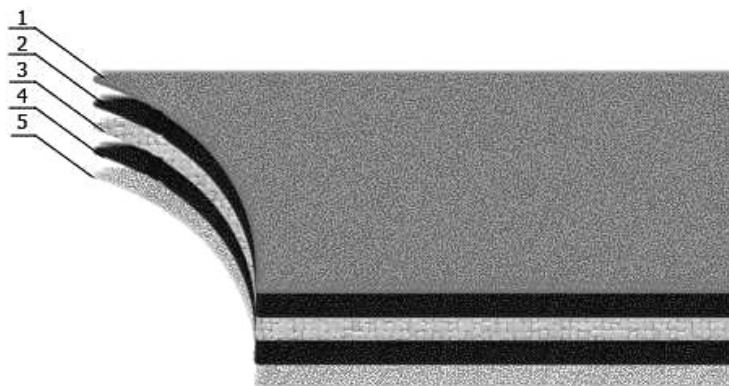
Общий вид продукции: 1 – верхний защитный слой (крупнозернистая или мелкозернистая посыпка, или пленка); 2 – верхний слой ПБВ; 3 – основа (нетканый полиэстер); 4 – нижний слой ПБВ; 5 – нижний защитный слой (пленка).
